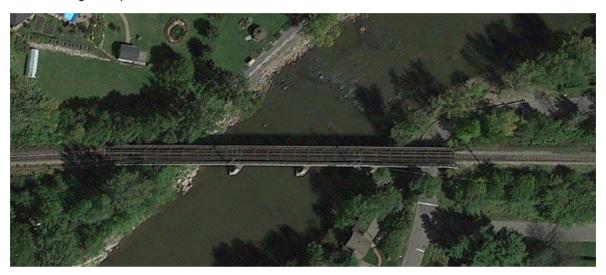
Section 1 - Pont du bras nord de la rivière des Prairies
